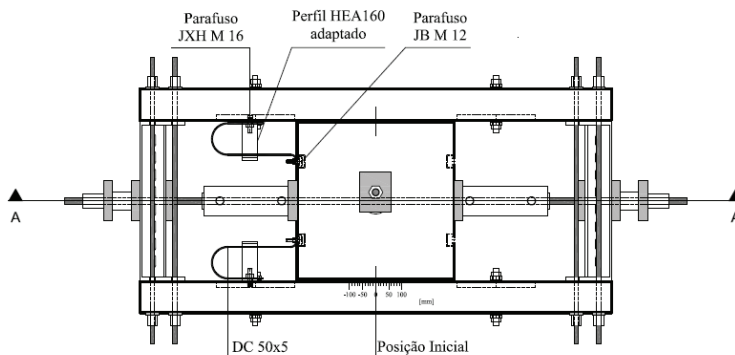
Planta do esquema de ensaio com o pilar no centro, as duas paredes de fachada e os dispositivos DC50x5
